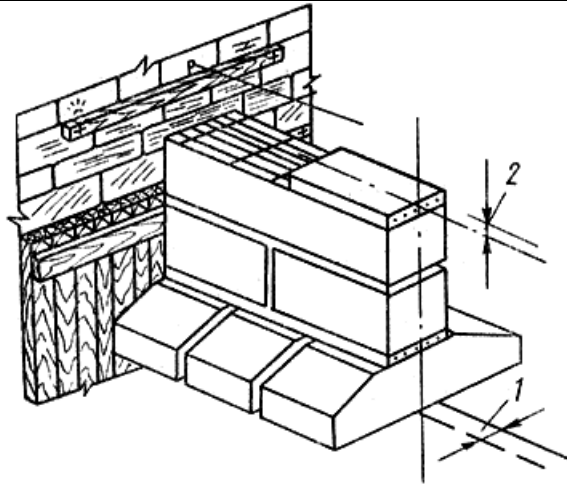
Допускаемые отклонения при монтаже сборных фундаментов
